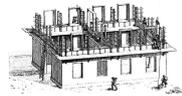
Zeichnung eines im Bau befindlichen Betonhauses des Architekten Bernhard Liebold um 1890..... 17
